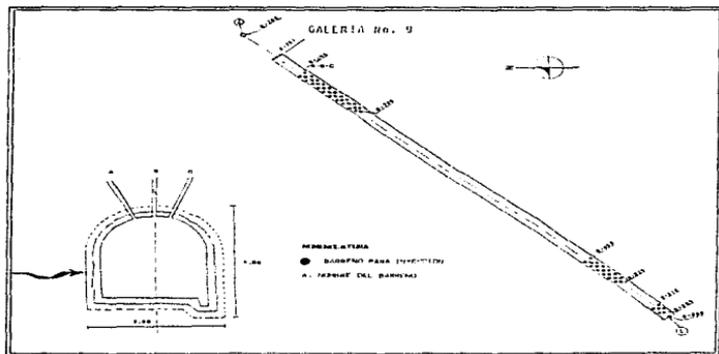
Inyección de contacto concreto - roca galería No 9
